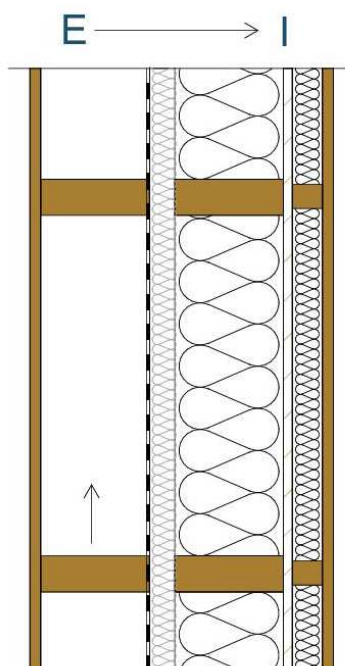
Panelová konstrukce stávajícího detailu nároží obvodových stěn-oblast kondenzace
